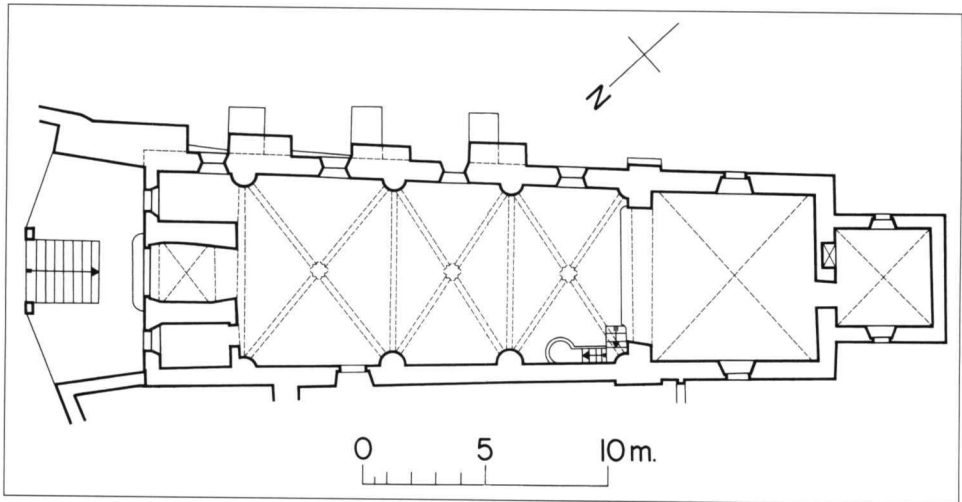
Brig, Antoniuskirche, Grundriss.
